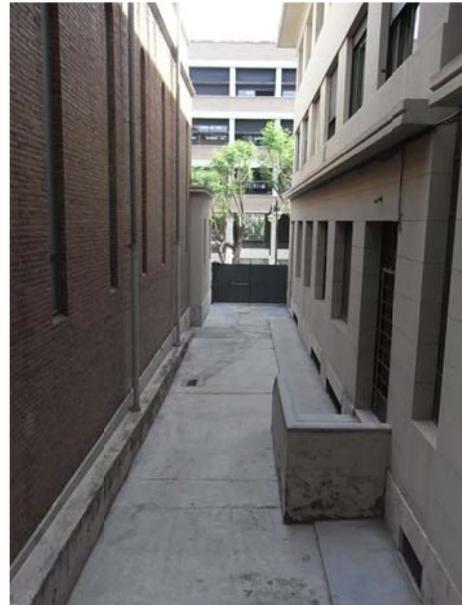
Detalles de tipología y estado de conservación de la carpintería de fachada.
